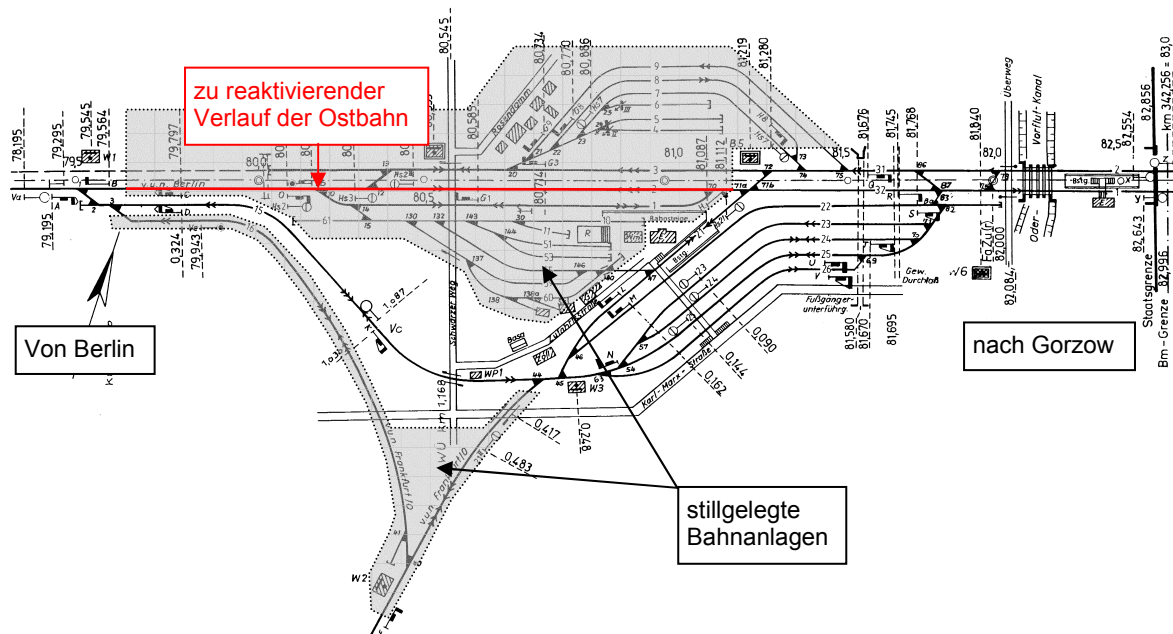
unmaßstäblicher Lageplan des Bf Küstrin-Kietz
